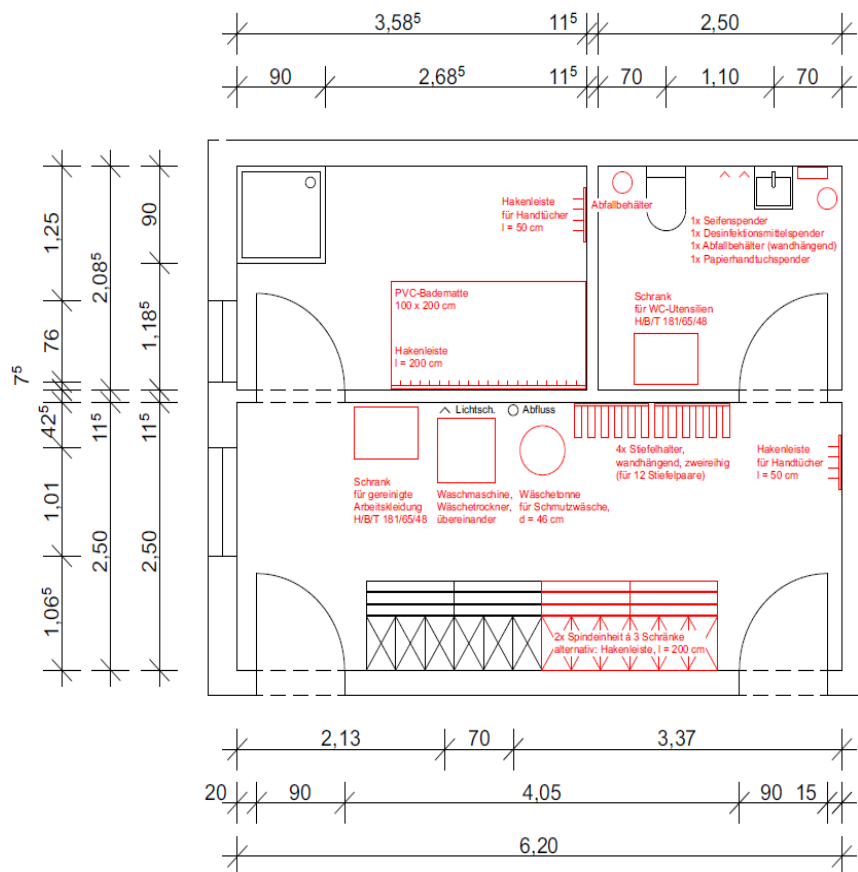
Grundriss der HS (Fallbeispiel)
